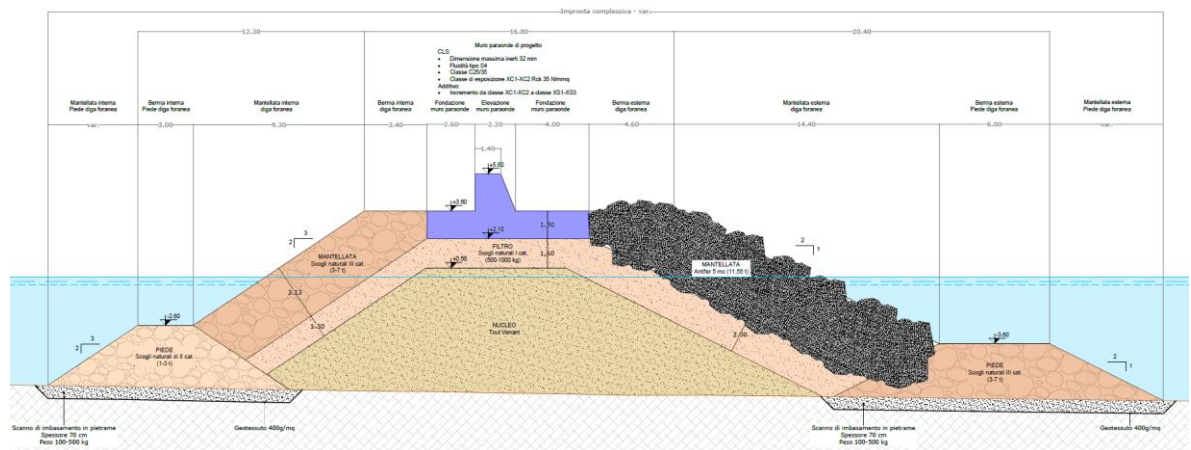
Sezione tipo della diga foranea di Soprattutto
